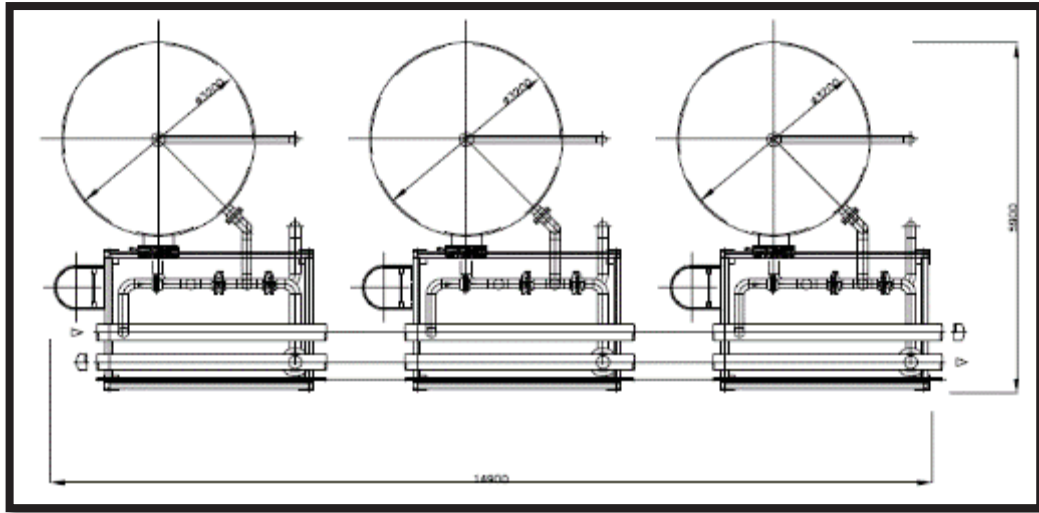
Plano sistema de filtrado SWS (Vista superior).
